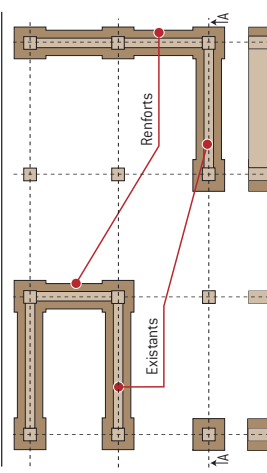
Exemple de renforcement de poteaux, murs, par chemisage en béton projeté (vue en plan et coupe AA')
